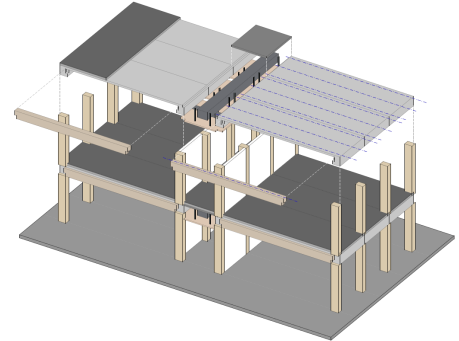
Konstruktionsprinzip, Dreilingsweg, © ArgeFRB
